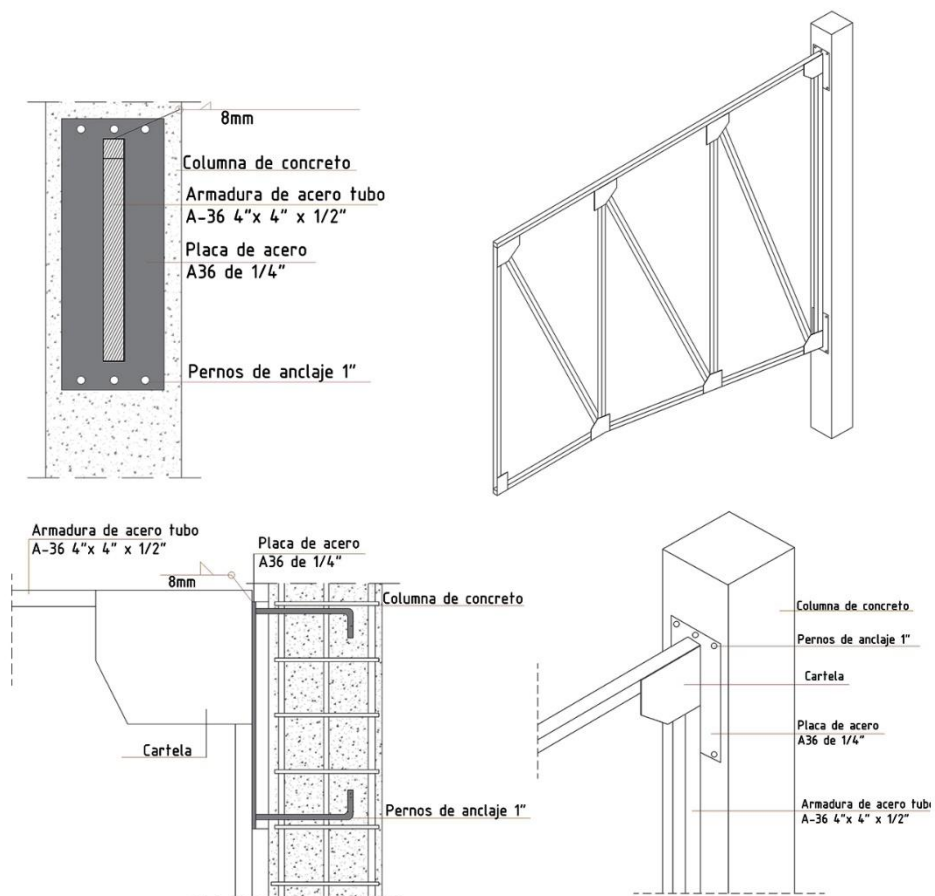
Detalles unión estructural metálica con columna de concreto. Elaboración propia.
